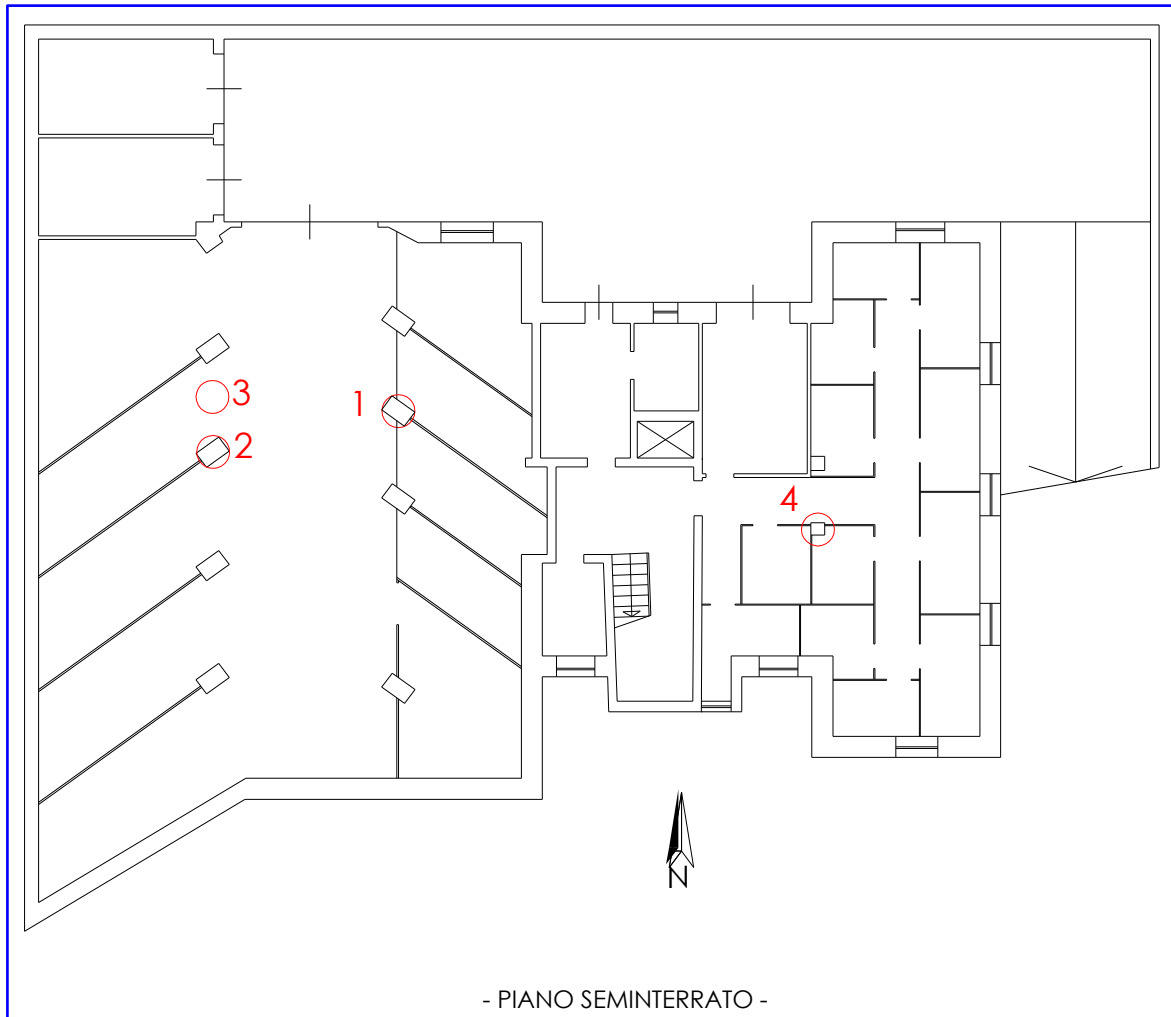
Planimetria del piano seminterrato (L-1) con l'ubicazione delle zone esaminate
